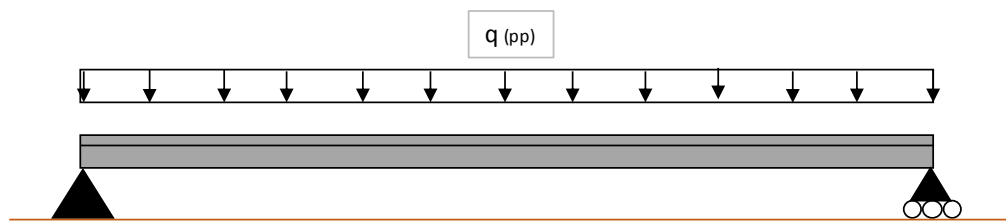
Viga simplemente apoyada con una carga distribuida
